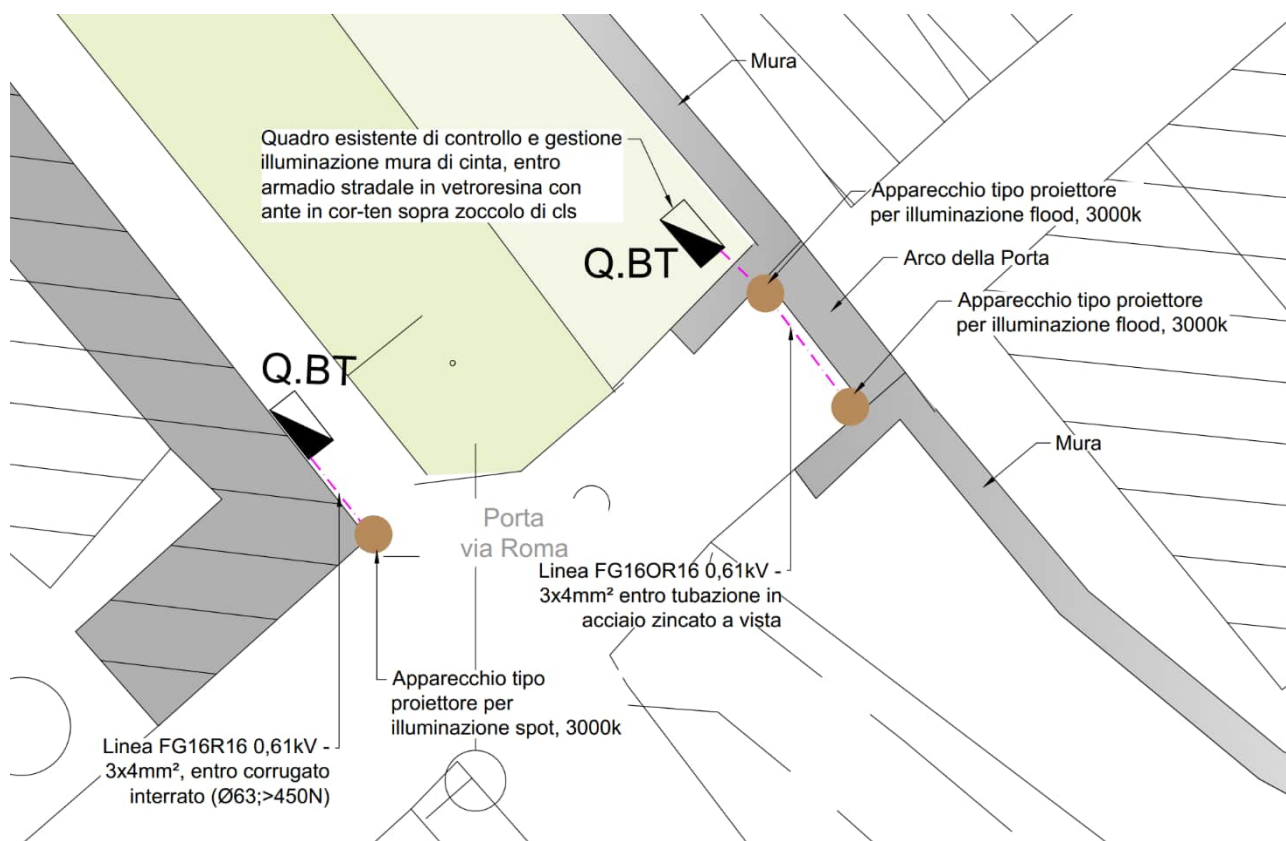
Planimetria di progetto illuminazione Porta di Sotto
